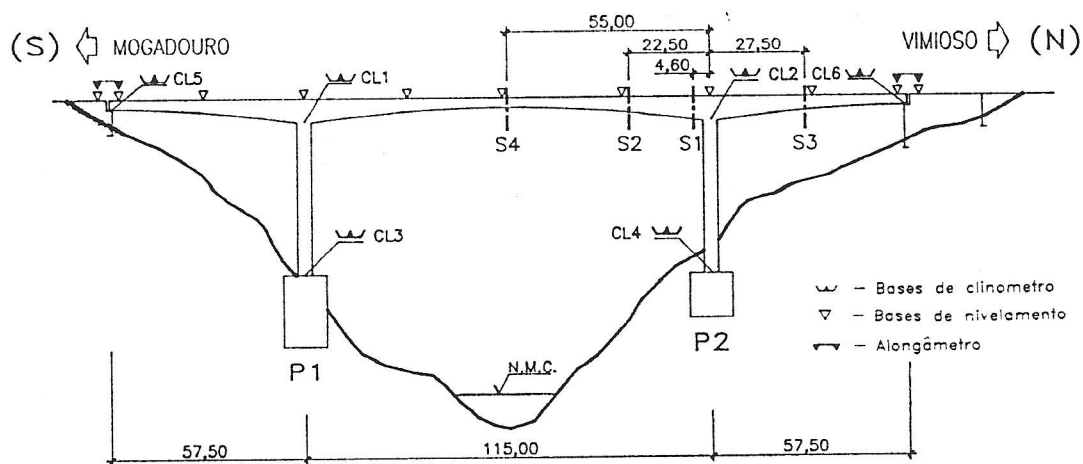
Plano geral da instrumentação da ponte de Angueira
